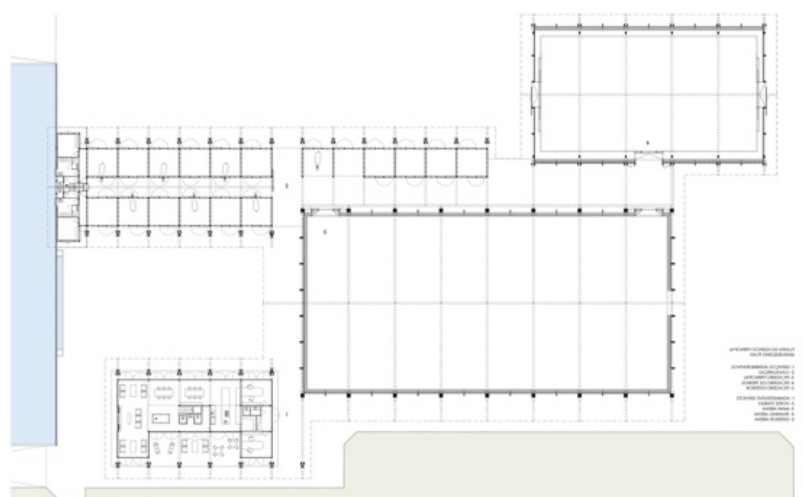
| Planta de implantação, geral | Cabo do Mundo | Carlos Castanheira & Clara Bastai | 2012
